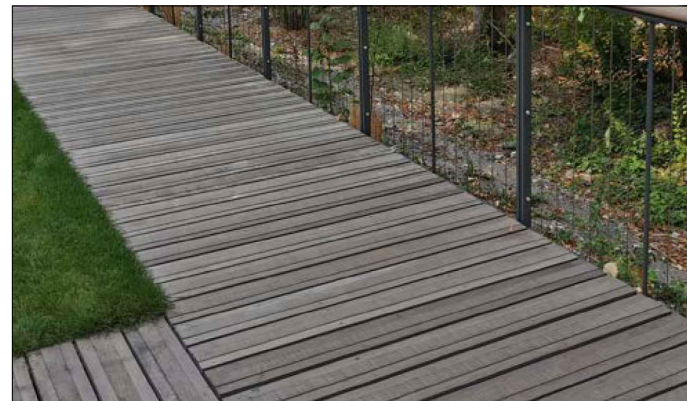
# DETAIL GENERAL DE PRINCIPE SUR LES PLATELAGES BOIS AVEC LAME EN RELIEF ANTIDERAPANTE
